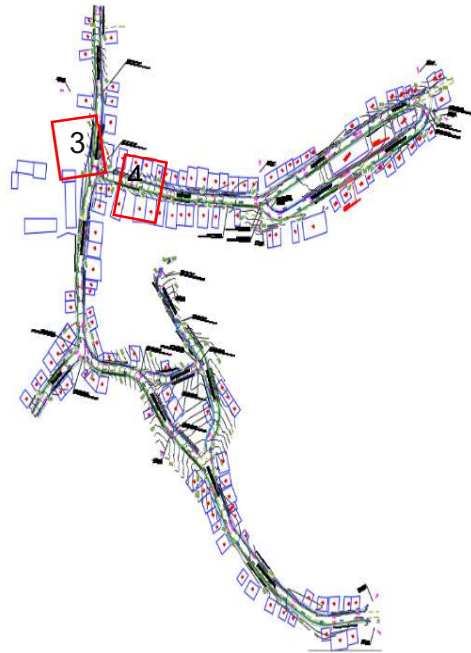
Vista del sistema de drenaje existente en Jr. Lamas Cdra. 02 y Jr. Cuñumbuqui Cdra. 01
